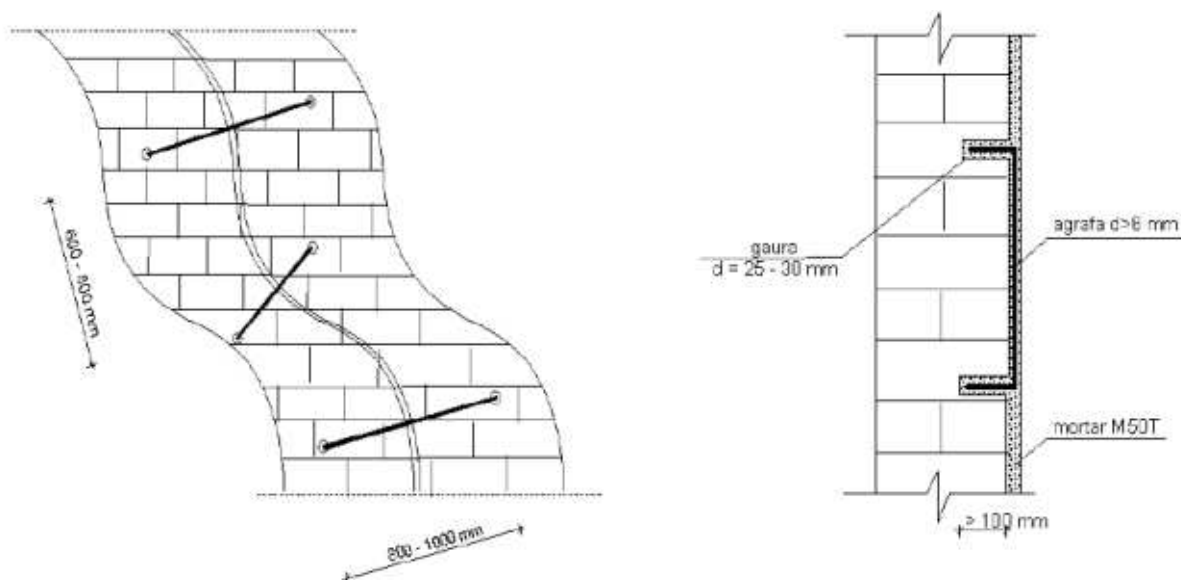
Detaliu de remediere a fisurilor cu agrafe din otel-beton
